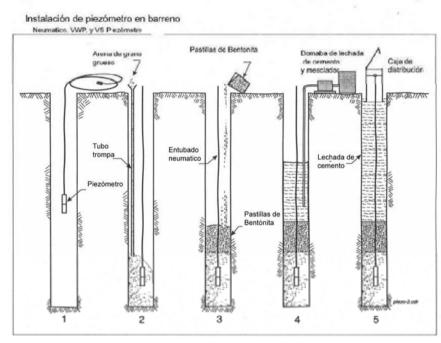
Procedimiento de instalación del Piezómetro
